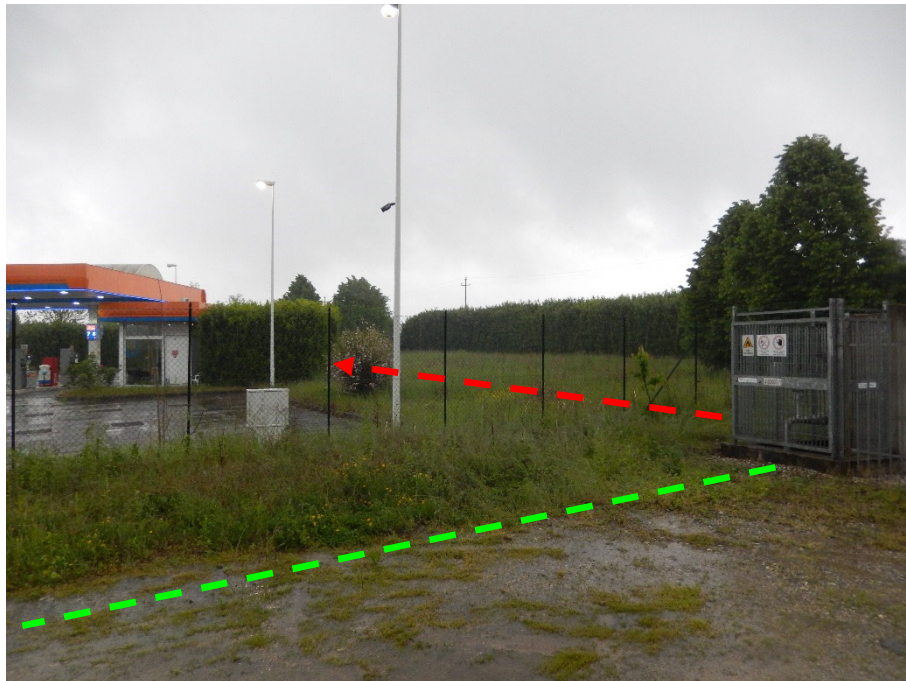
ATTRAVERSAMENTO CANALE SANTA MARIA
